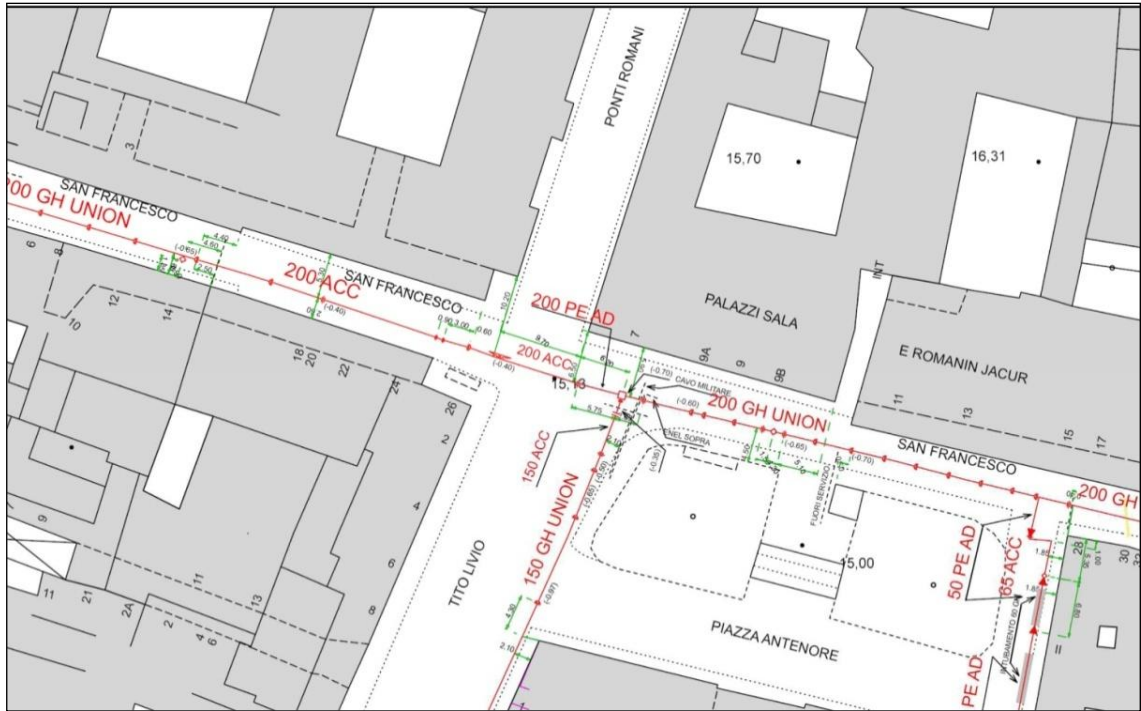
Planimetria con le tubature del gas (AcegasAps).
